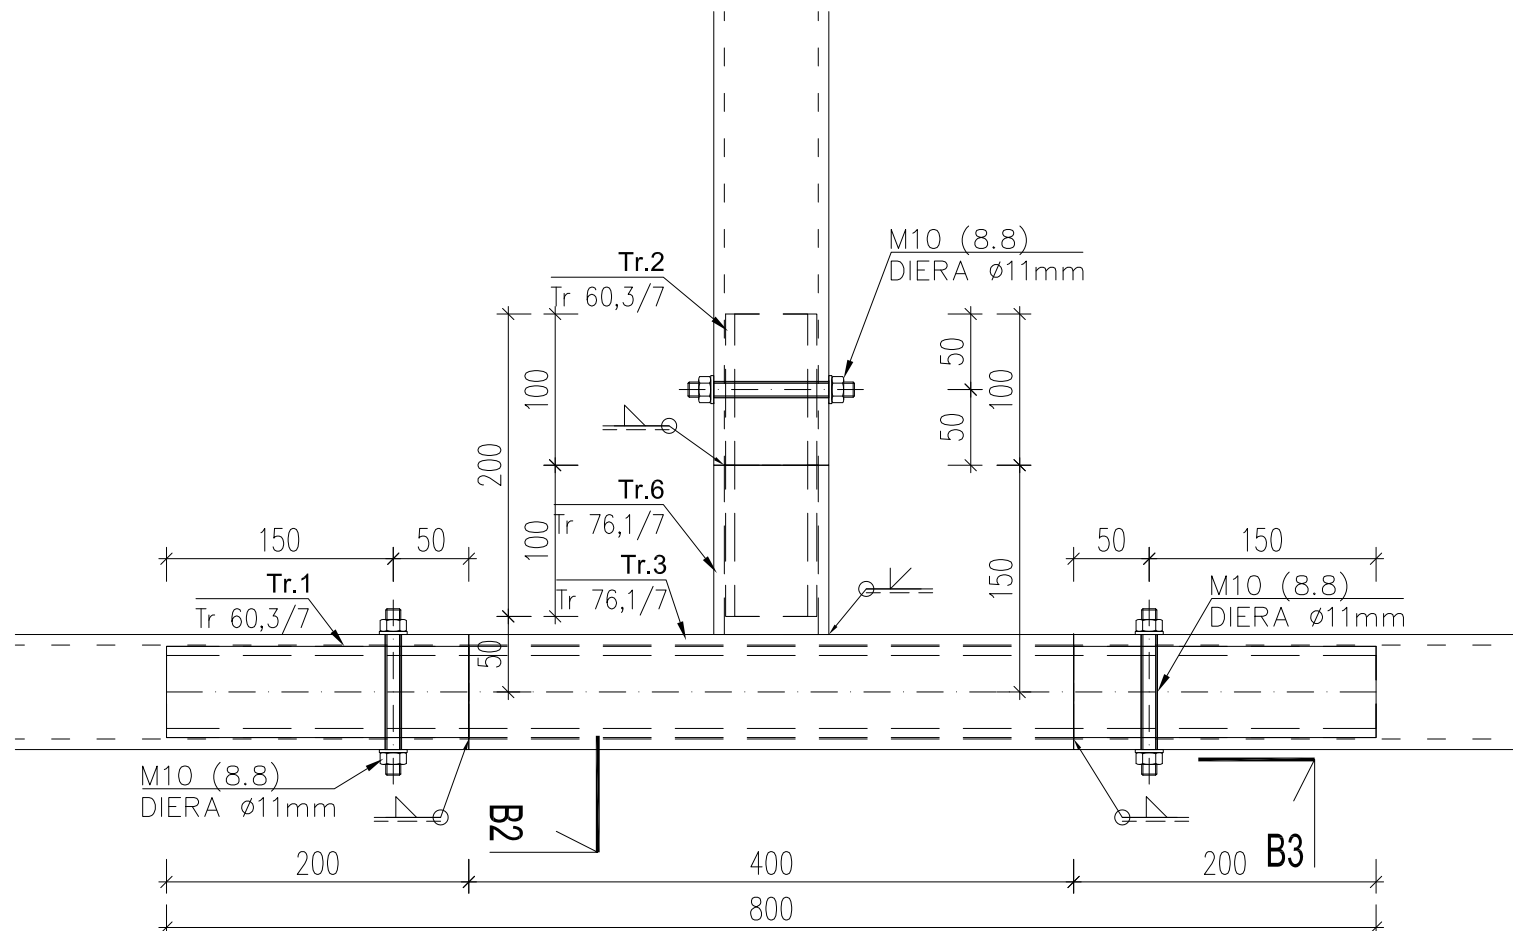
DETAIL "B" - REZOPOHĽAD B3; M 1:10
